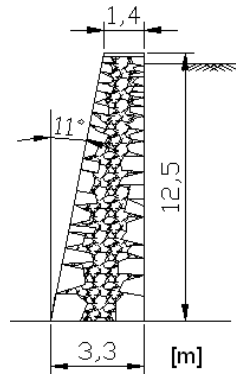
Secção transversal tipo do pano SE da muralha (Dezembro de 2005)
